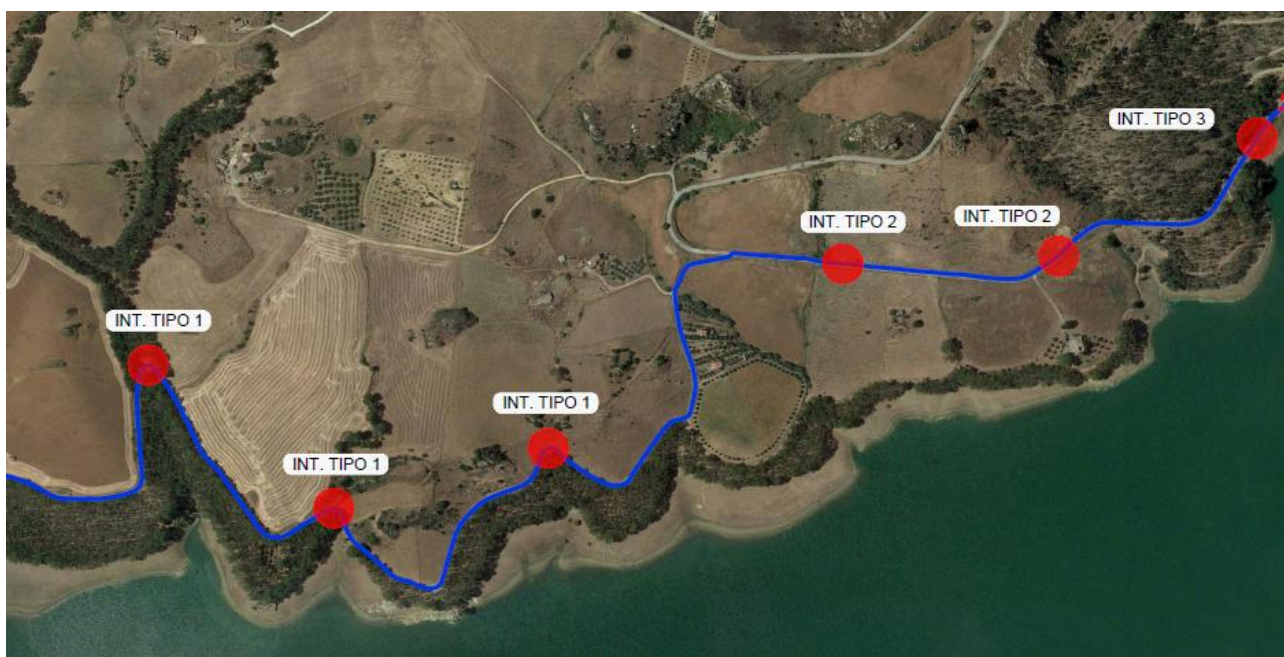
Vista di dettaglio 2 estratta dall'elaborato "Percorsi di cantiere e ubicazione dei siti di cava e di deposito"
